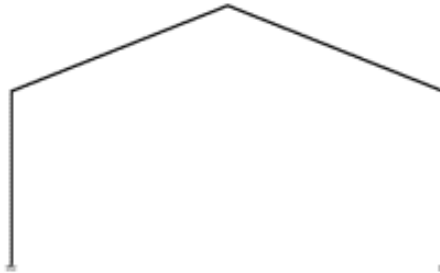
Nave simple a dos aguas. Pórtico rígido
